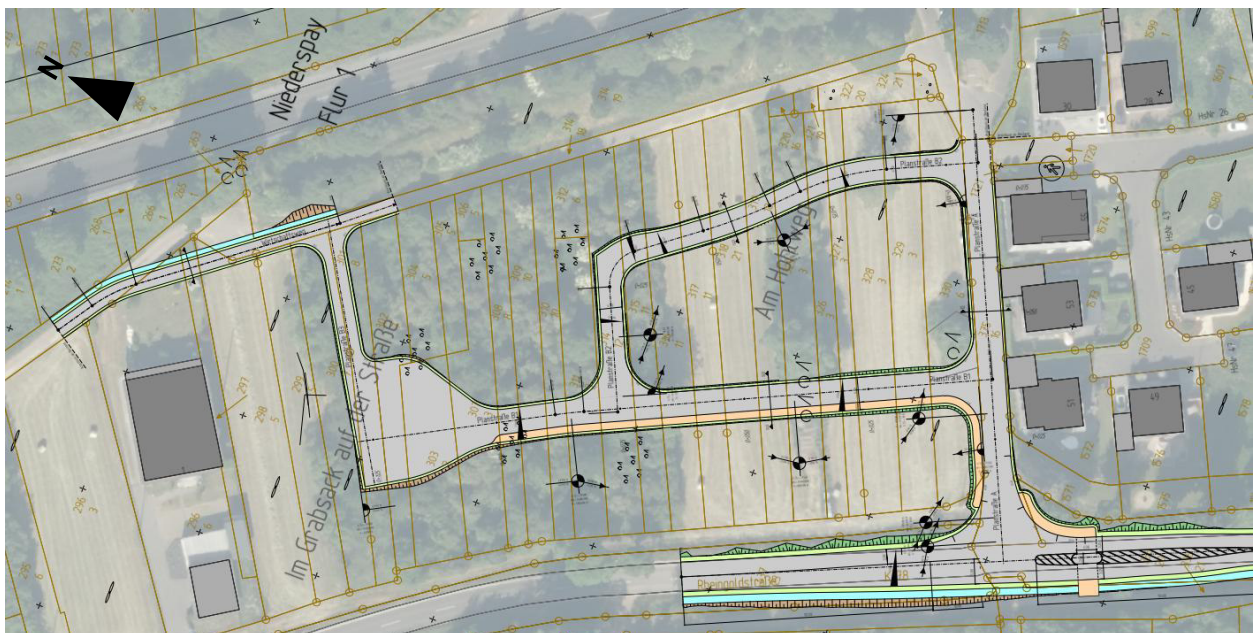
Ausschnitt des Lageplans der Verkehrsanlage (ohne Maßstab)
